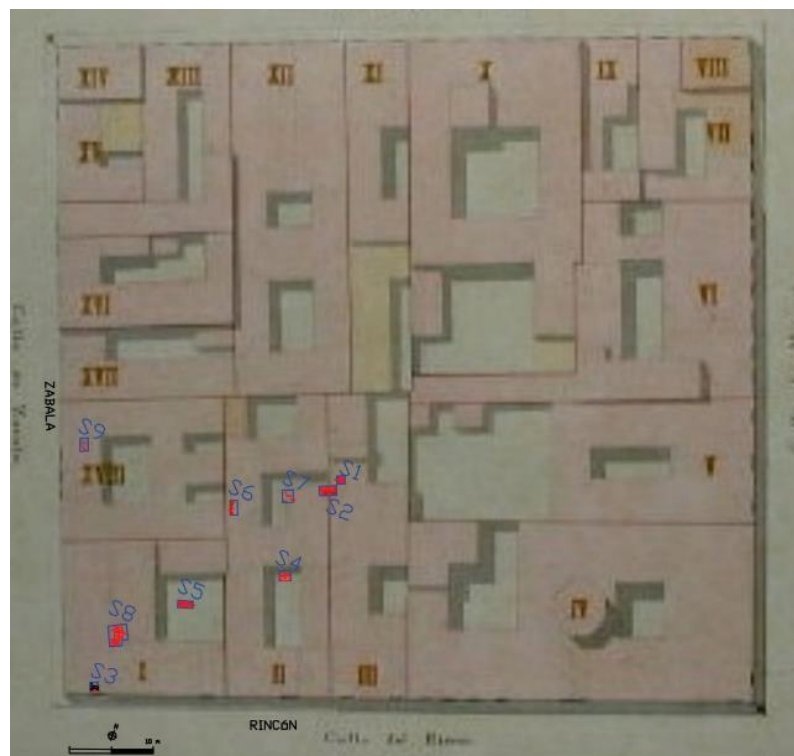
Detalle de ubicación de sondeos en plano de Capurro 1871
